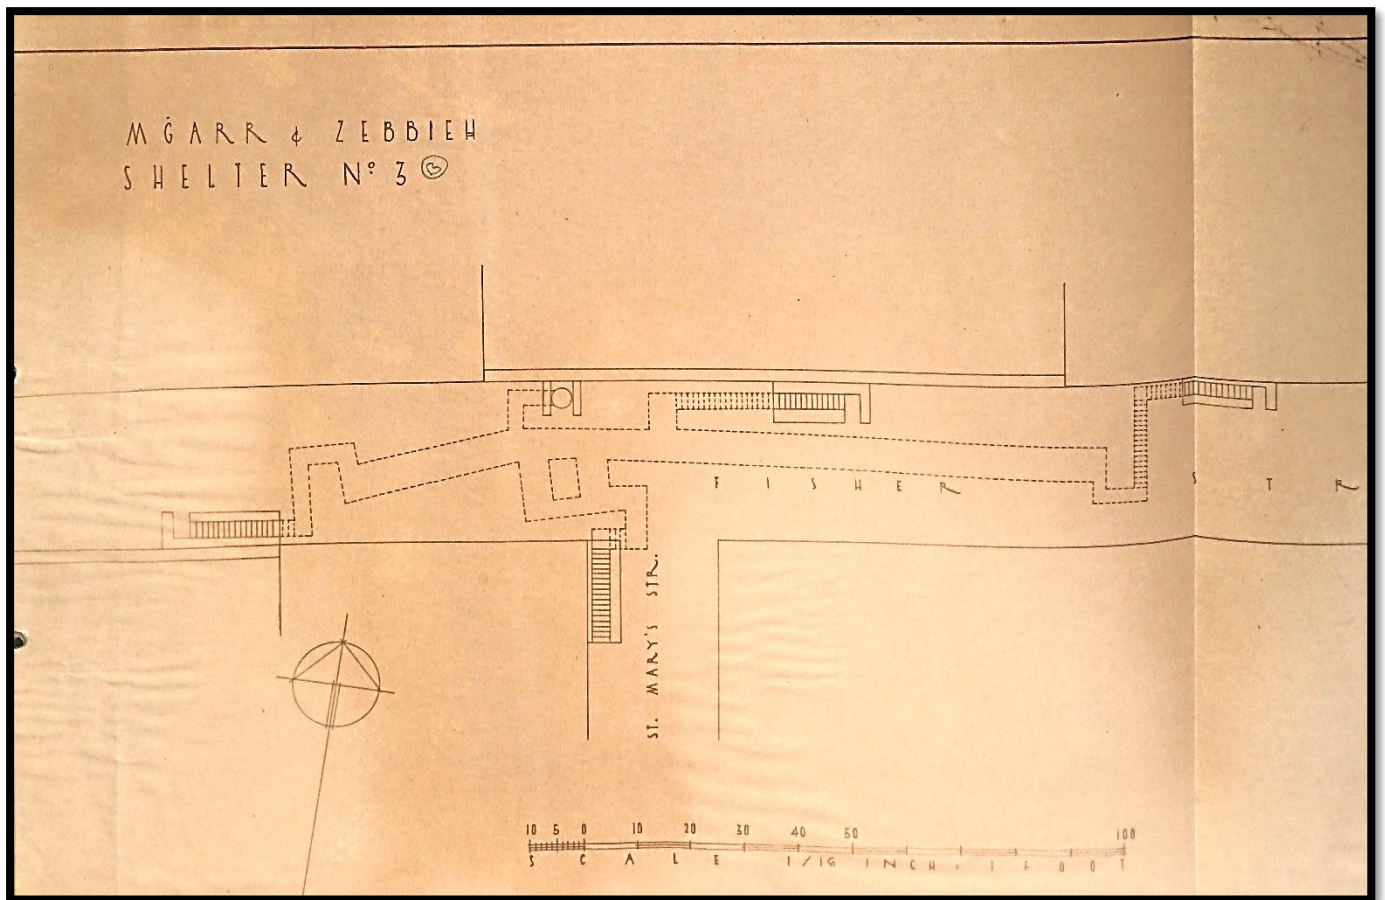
Planta do Abrigo nº3B. "St Mary's Str. – Fisher Str."
